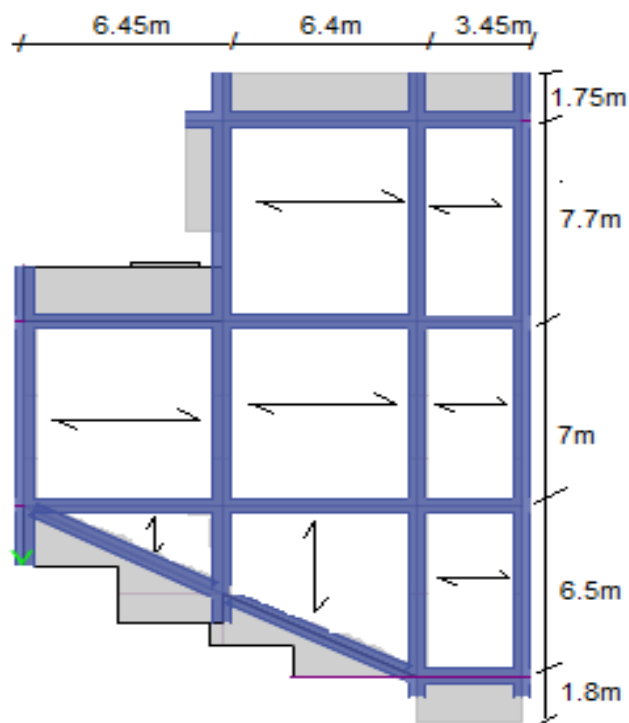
Plan de disposition des poutrelles terrasse inaccessible
